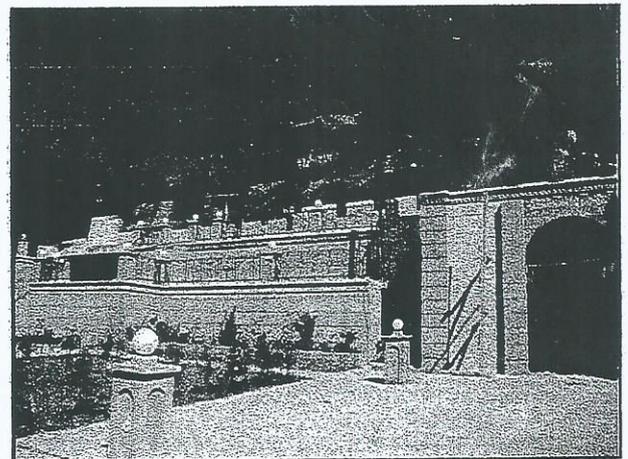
Vista de planta en área de Museo y comercio, Plaza de Naciones cono rumbo de Norte a Sur.
